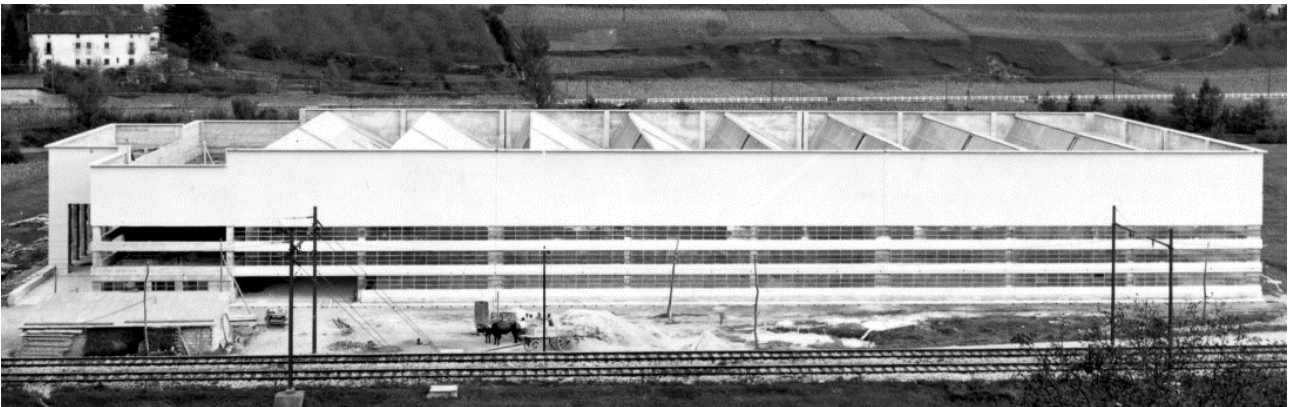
Vista lateral del pabellón primitivo en construcción. (AMV)
